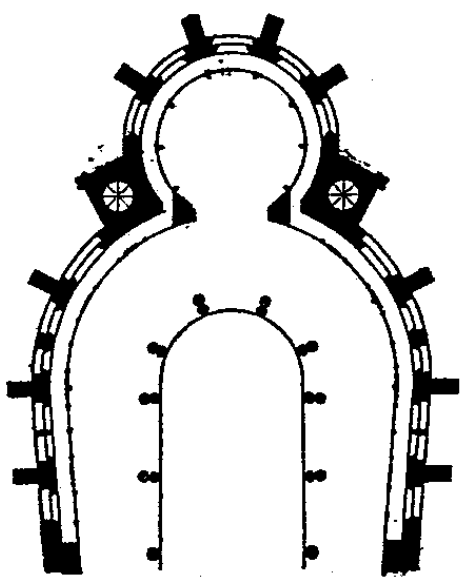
Plan de la chapelle absidale de la cathédrale de Cantorbery.
